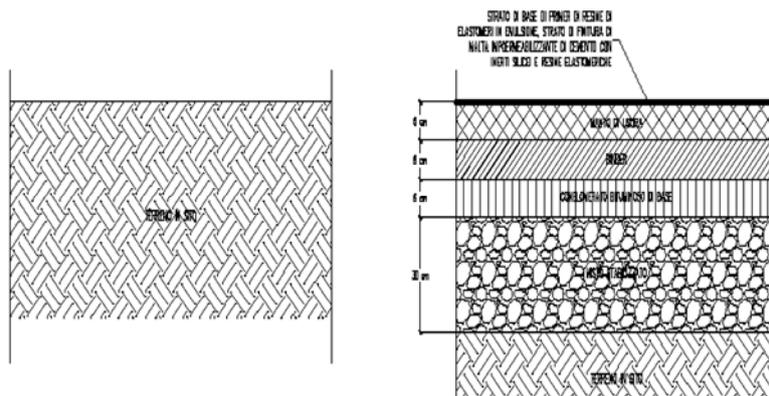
Sezione della pavimentazione della strada interna ante e post operam
